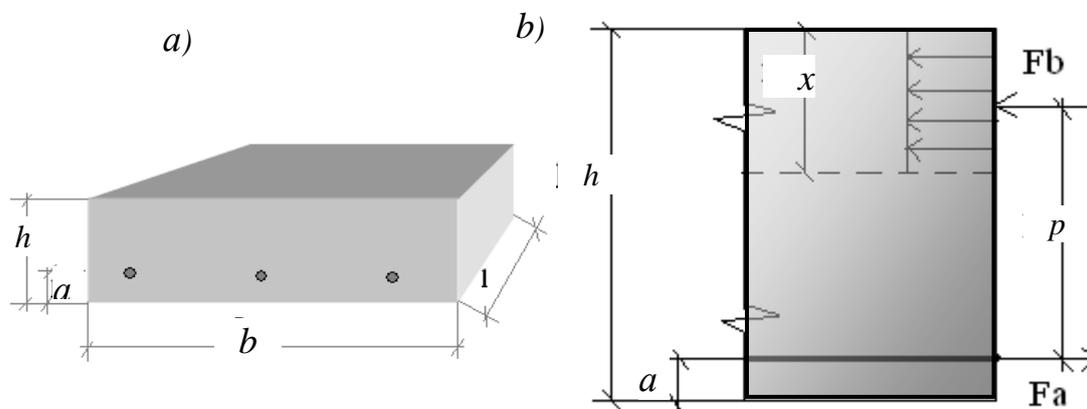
Общий вид (а) и расчётная схема (б) железобетонной затяжки
